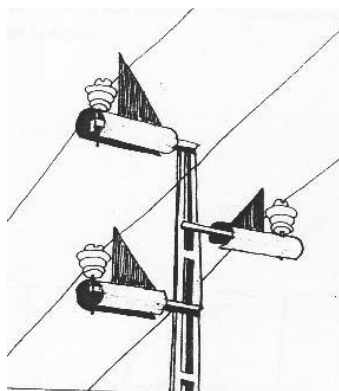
Tubo de PVC para aislar el travesaño
